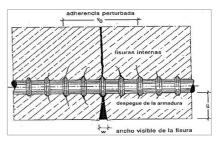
Fisuras por Tracción Pura Fuente: Investigación
